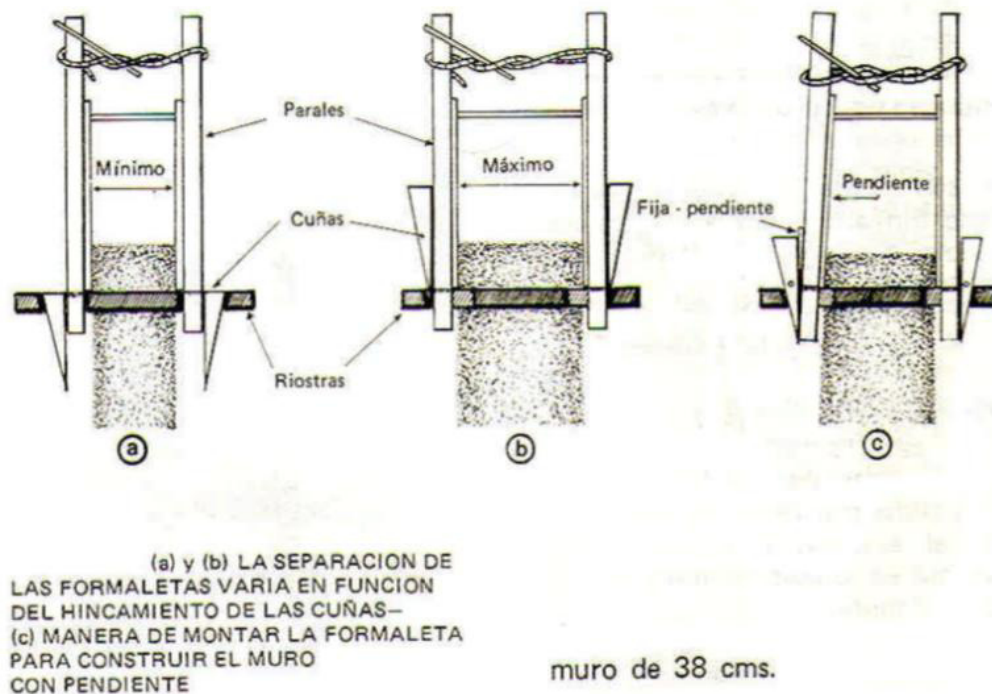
Separación de tablillas para anchos de muro (fuente: Tapia Pisada, Camino Sostenible, 2005)
